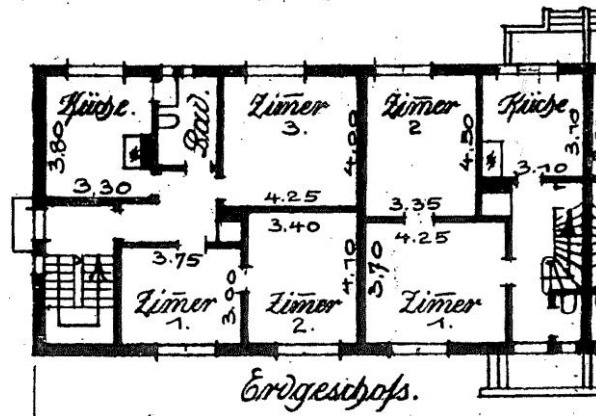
Typ 5, Grundriss Erdgeschoss
